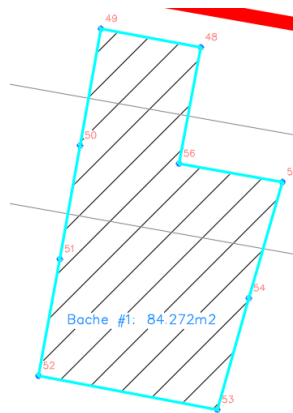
Vista en Planta de Bache #1 en Patio M.
